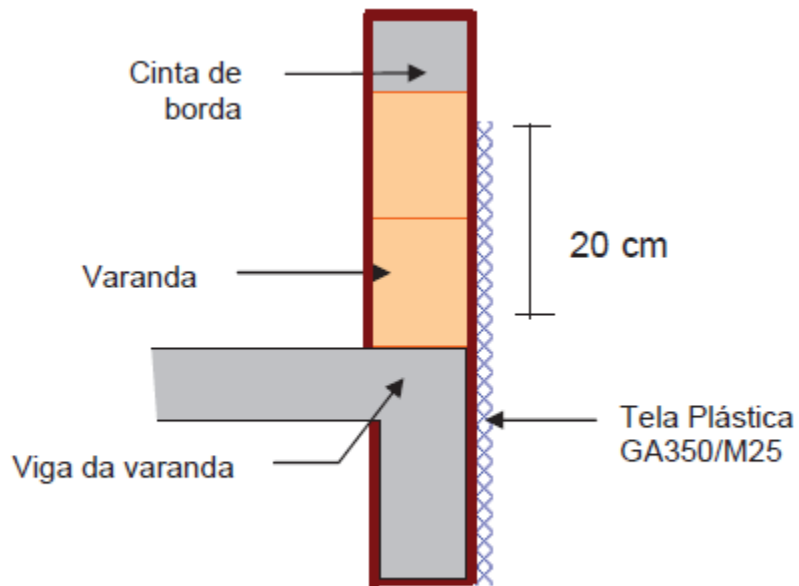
Detalhe genérico – reforço de varandas/jardineiras
